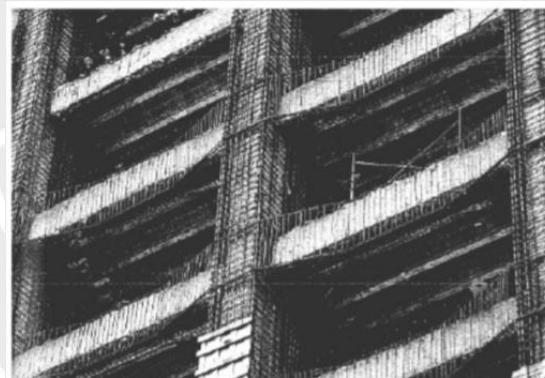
Encamisado de columnas y vigas en obra (La Torre, 2019)
